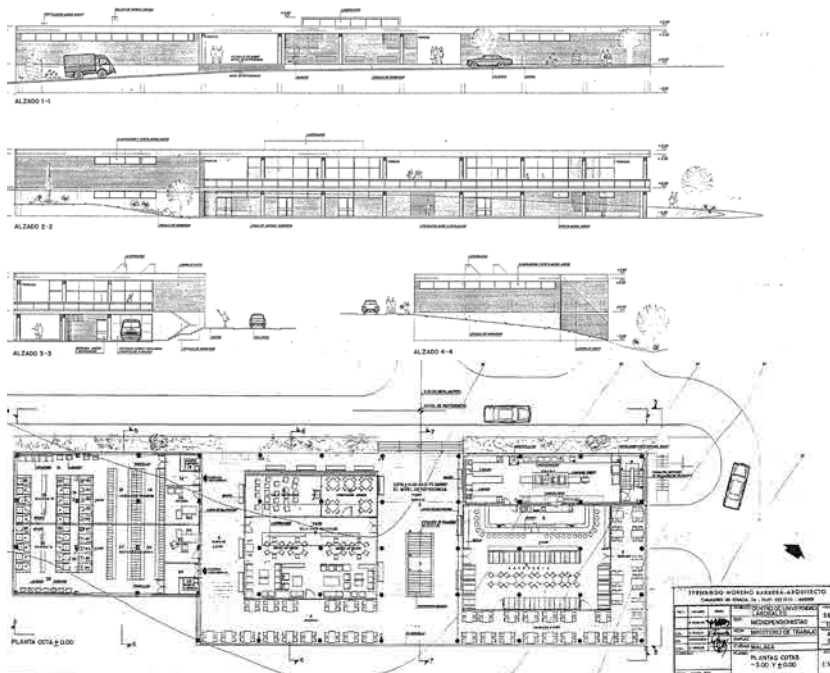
, Fig. 83, Fig. 84, Fig. 85 y Fig. 86 Edificio de mediopensionistas. De arriba a abajo: alzado de la fachada Norte o principal, alzado de la fachada Sur o posterior, alzados de las fachadas laterales Este y Oeste, y planta superior o principal.
